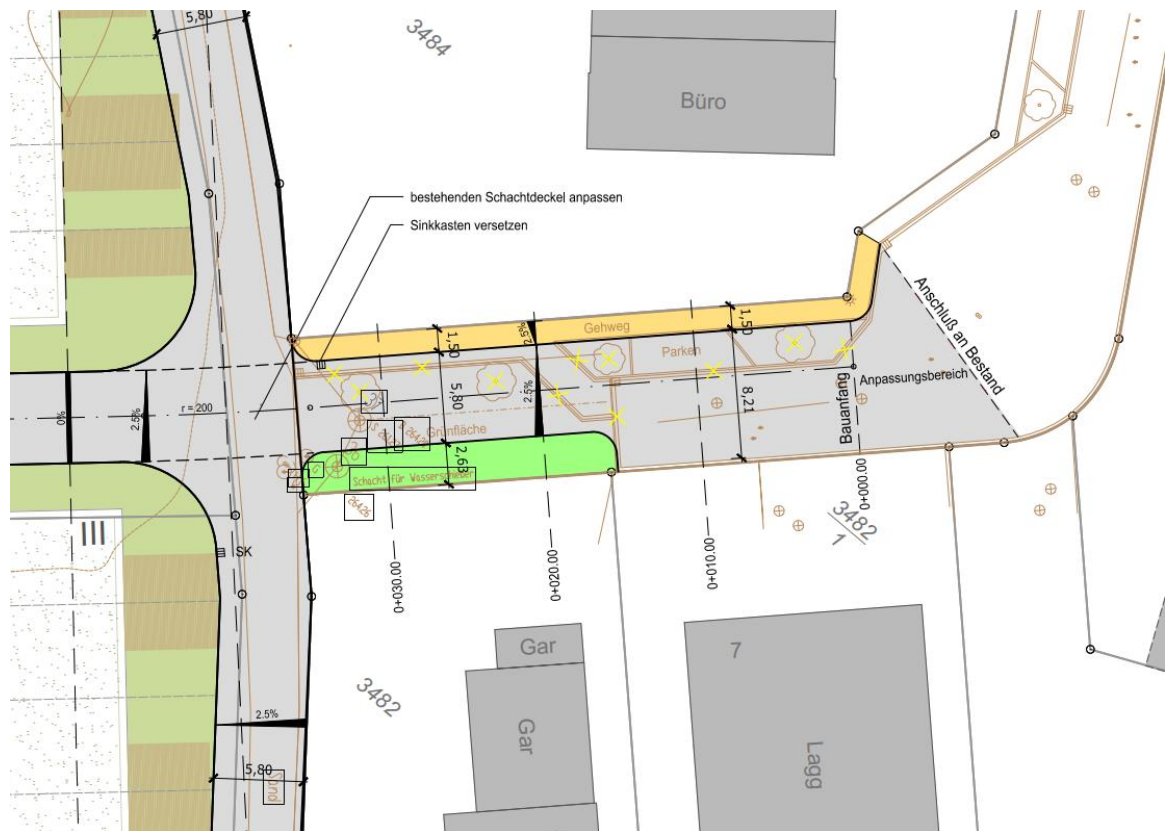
geplanter Umbau Übergangsbereich Reibmattenstraße - Malzholzweg
